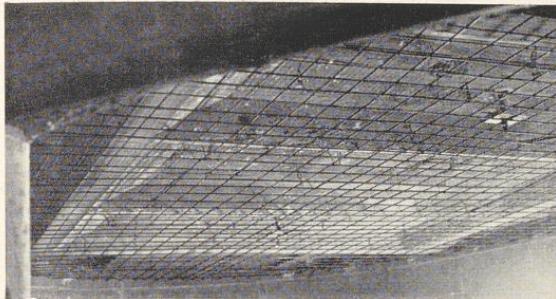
An Eisenbetondecke aufgehängte Rabitzkonstruktion
